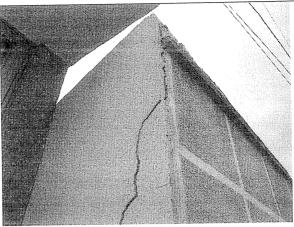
Fisuras y agrietamientos en la parte superior de la fachada del inmueble de la carrera 111 # 140 A – 51.
